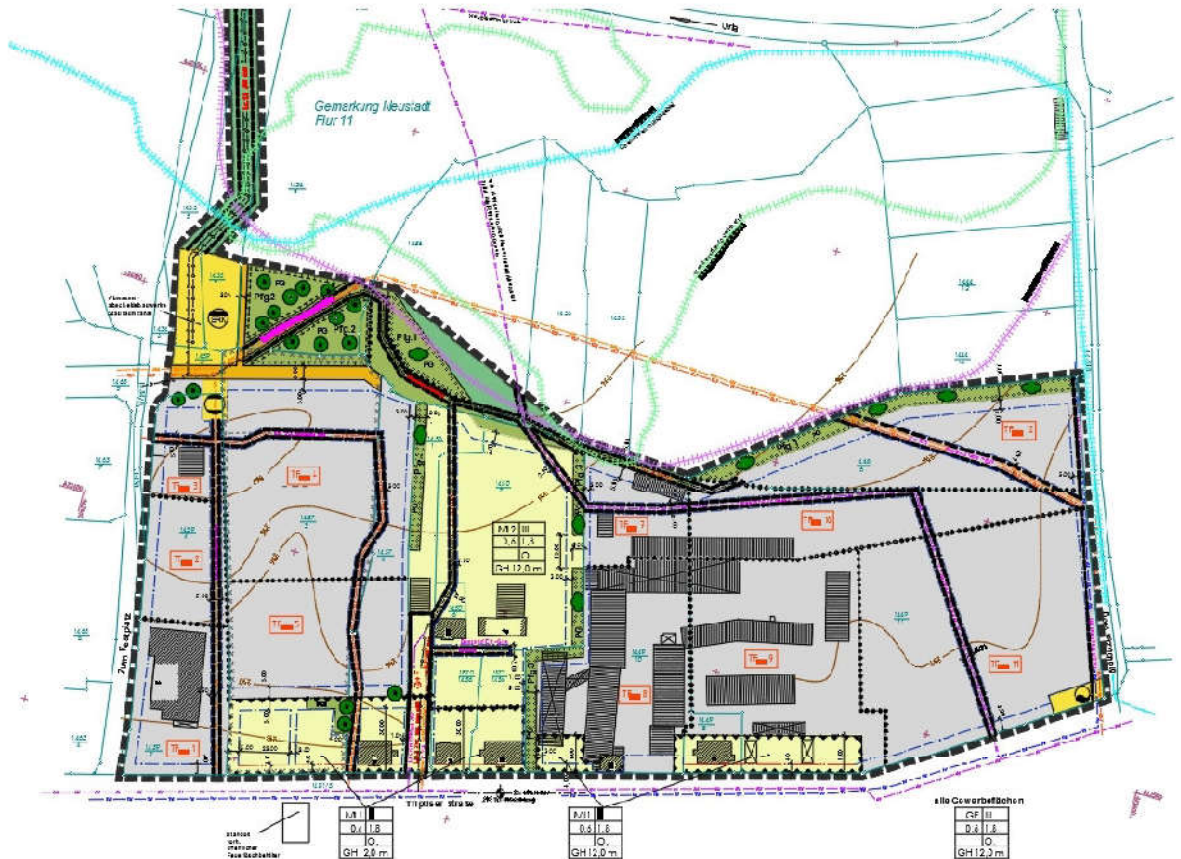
Bebauungsplan Triptiser Straße - 1.Änderung – Lageplan
